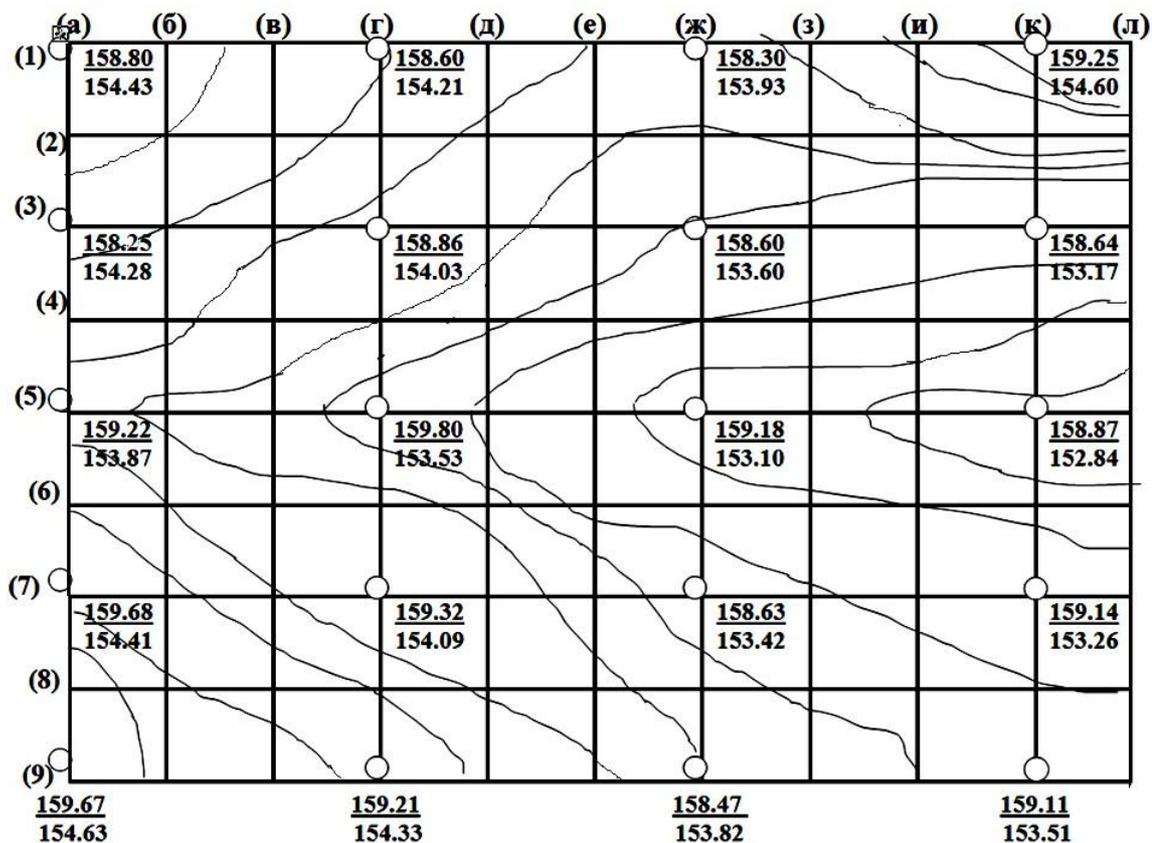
План майданчика в ізогісах (приклад 1)
